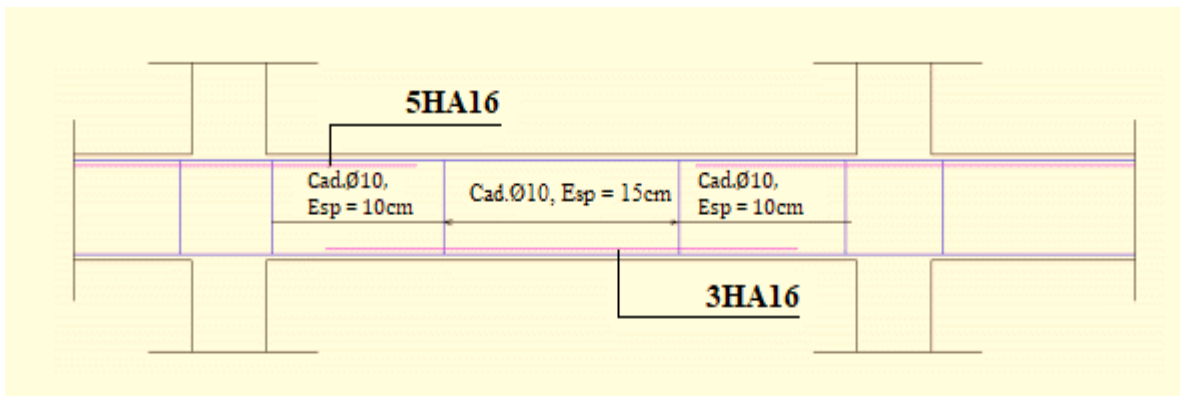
Recouvrement des aciers dans la poutre principale.
